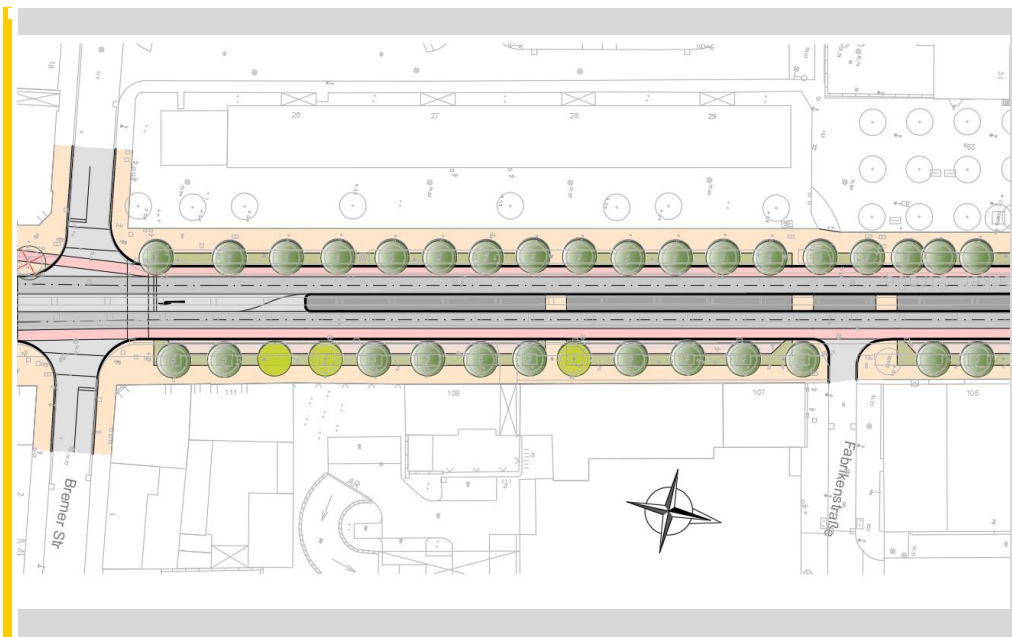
Lübecker Straße Nord, Lageplanausschnitt V3
